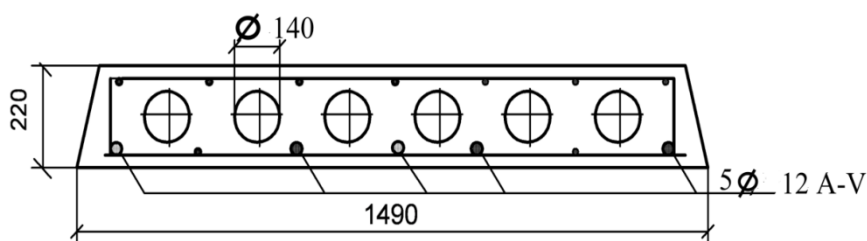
Разрез плиты перекрытия ПК 60-15-8 (1-1)
